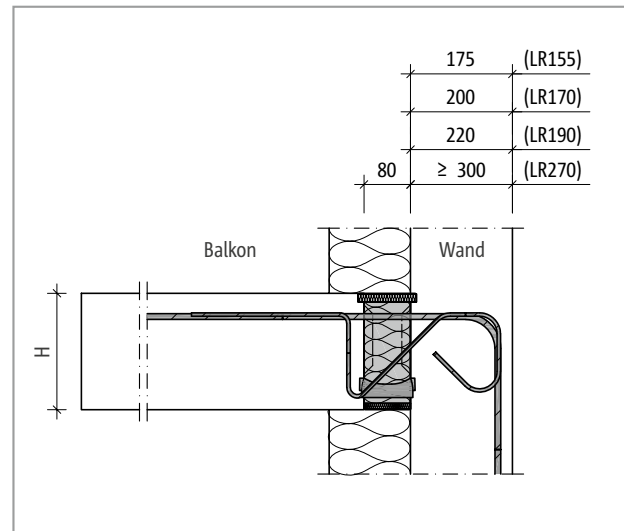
Schöck Isokorb® T Typ K-WU: Wandanschluss nach unten bei Außendämmung
